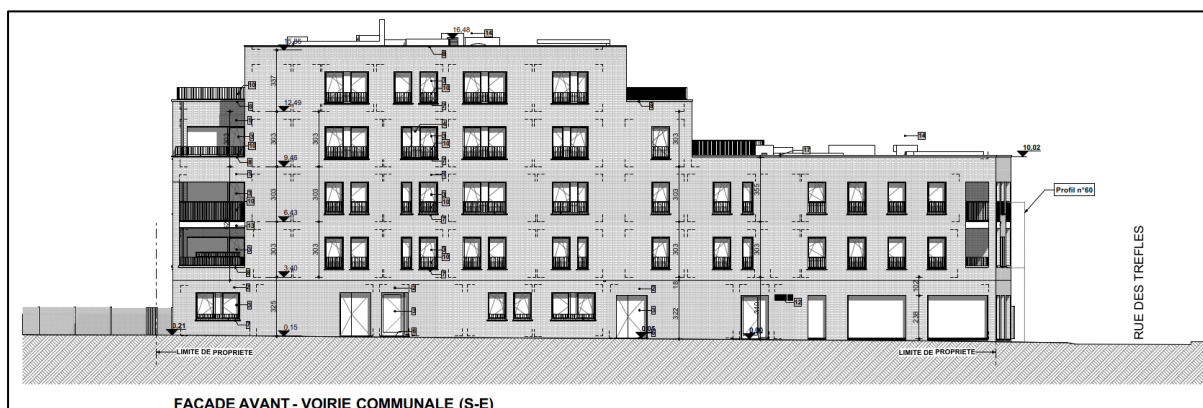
Façade avant du bâtiment 1 (source : Plans PU)
